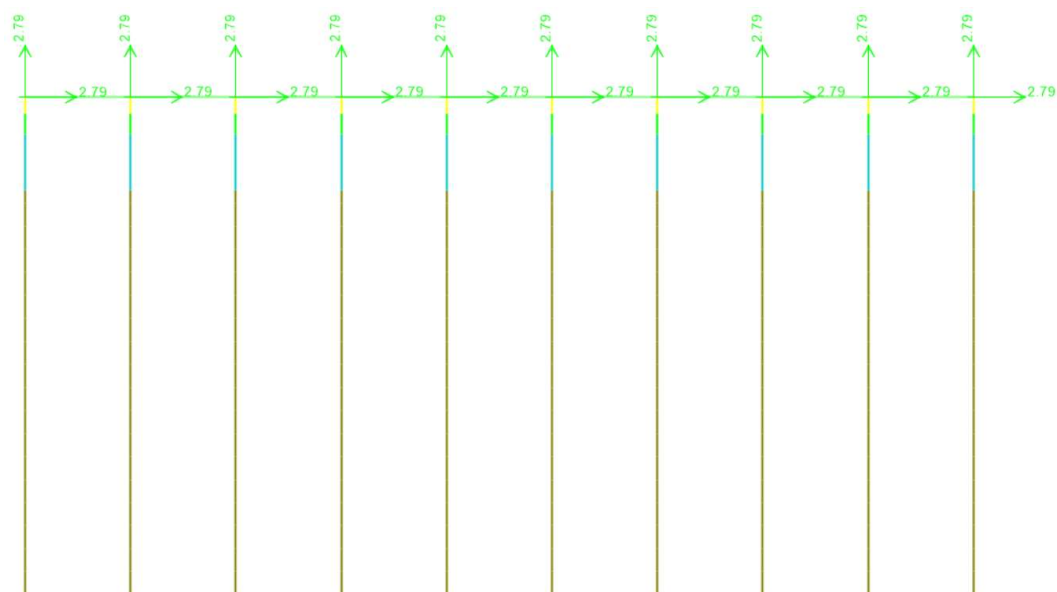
Joint Masses de pilotes verticales - Eje G (2.79 kN-s²/m)
